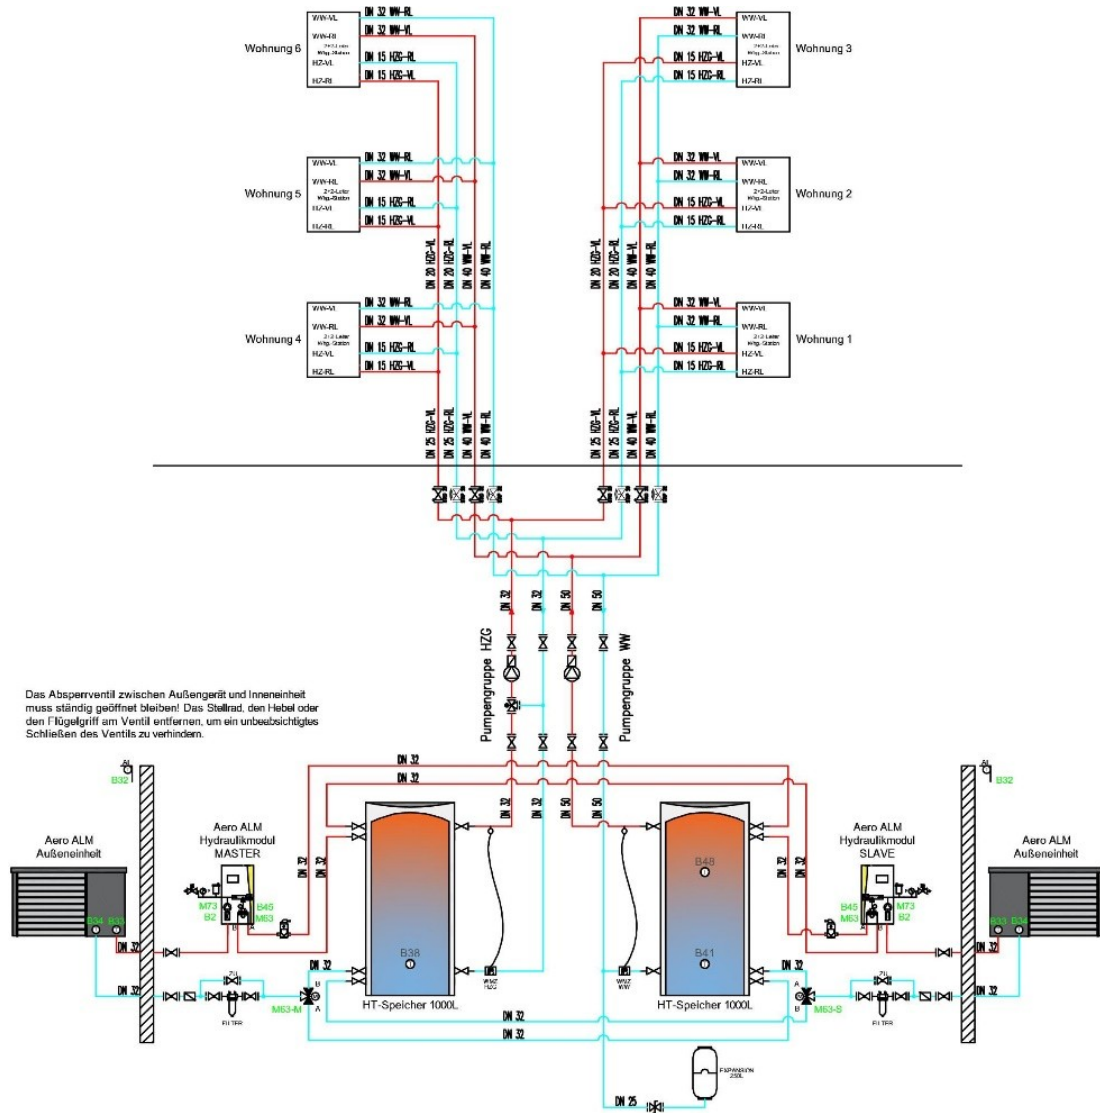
Hydraulisches Schema der Wärmepumpenanlage mit zentraler Heizung und Warmwasserbereitung. Quelle: Klimatherm / iDM.
